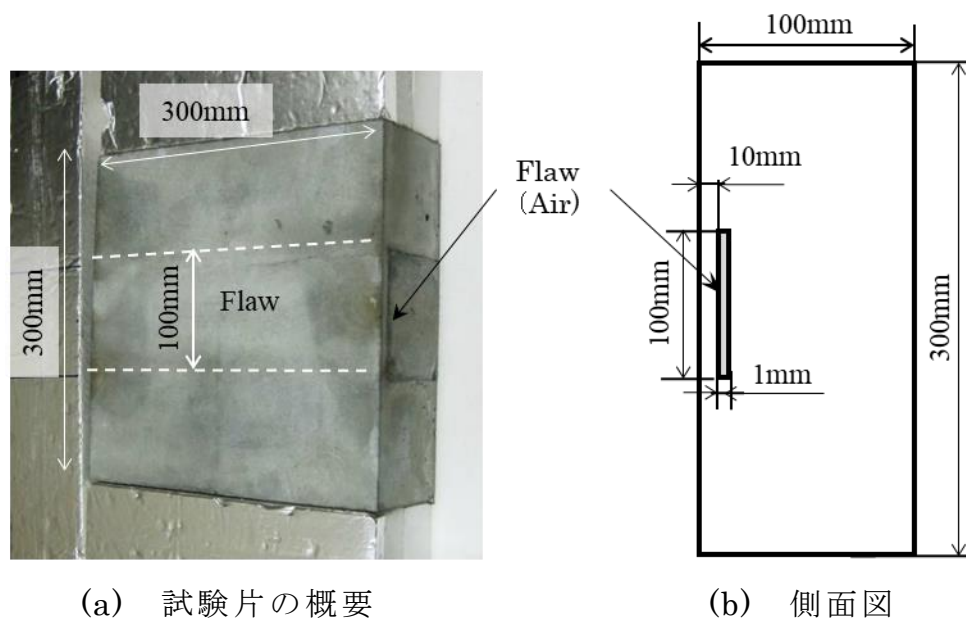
深さ 10mm のきずを有するコンクリート製試験片
